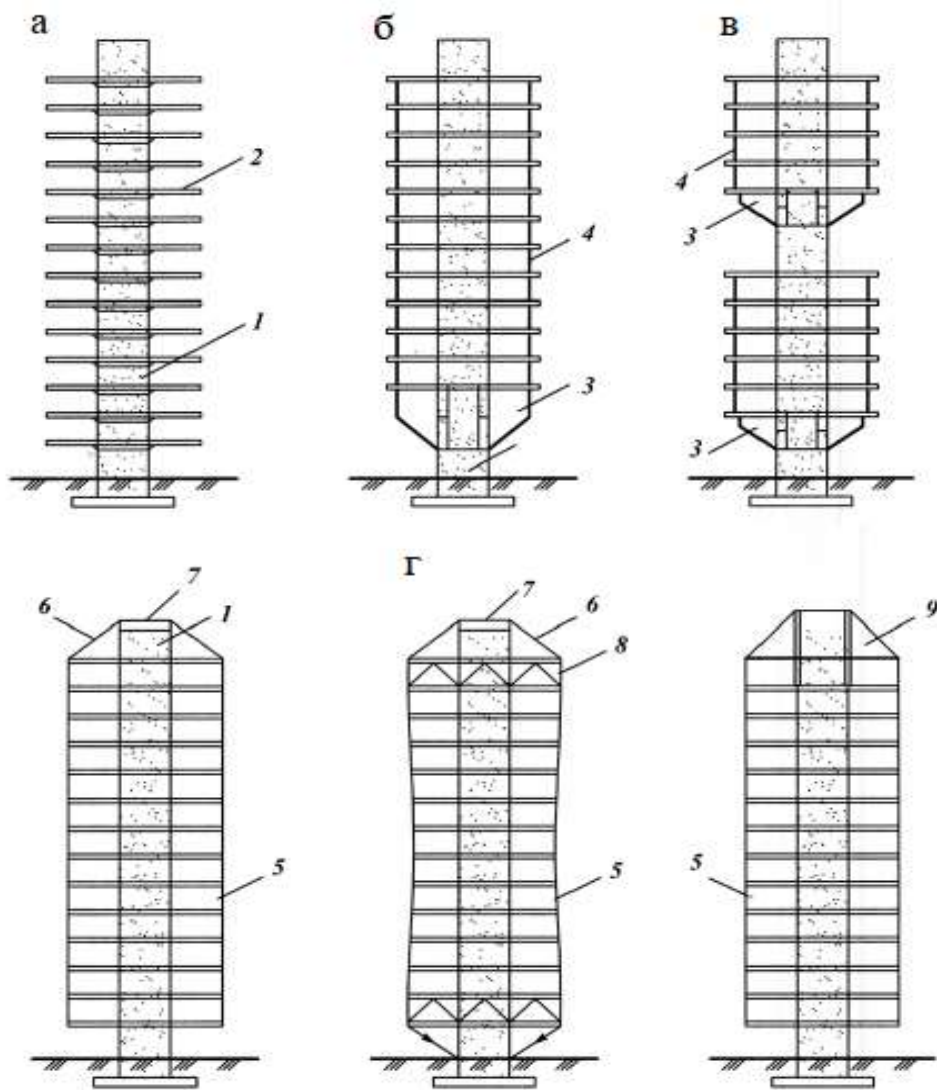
Основні конструктивні схеми будівель стовбурної конструктивної системи: а – з консольними перекриттями; б, в – з консольними платформами; г – з перекриттями, підвішеними на металевих підвісках до консольних оголовків; 1 – стовбур; 2 – перекриття; 3 – консольна платформа; 4 – фахверкова стіна; 5 – підвіска; 6 – відтяжка; 7 – анкерна обойма; 8 – металевий консольний оголовок; 9 – залізобетонний консольний оголовок
